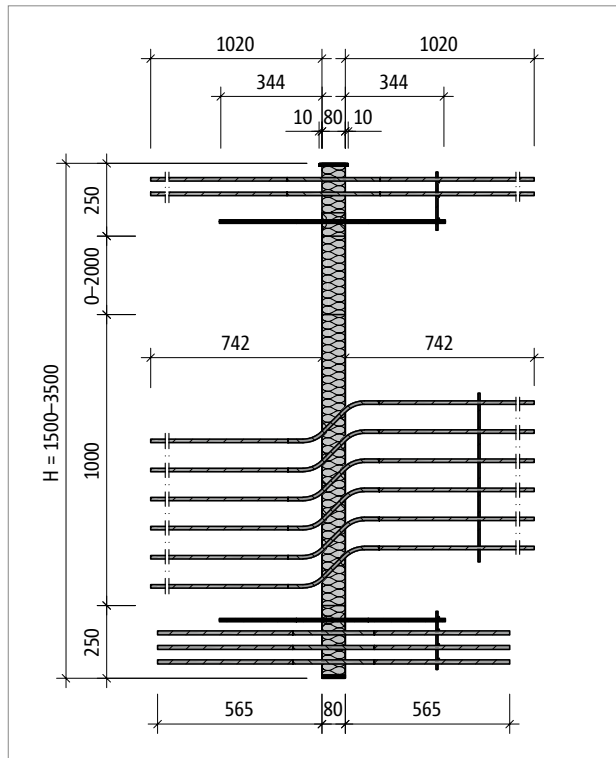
Schöck Isokorb® T type W-M4-R90: Product layout; fire protection board top and bottom
